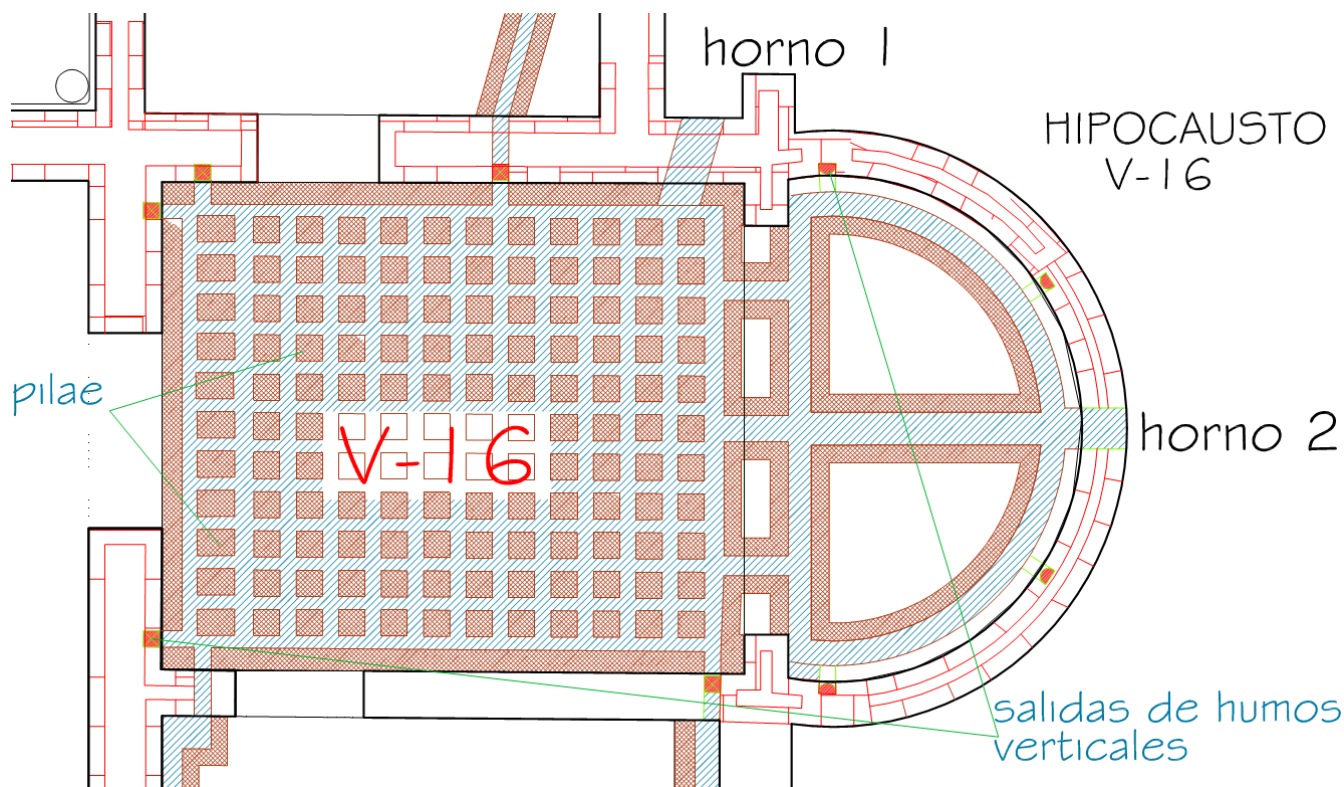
Planta del hipocausto de la habitación V-16. CGS.
